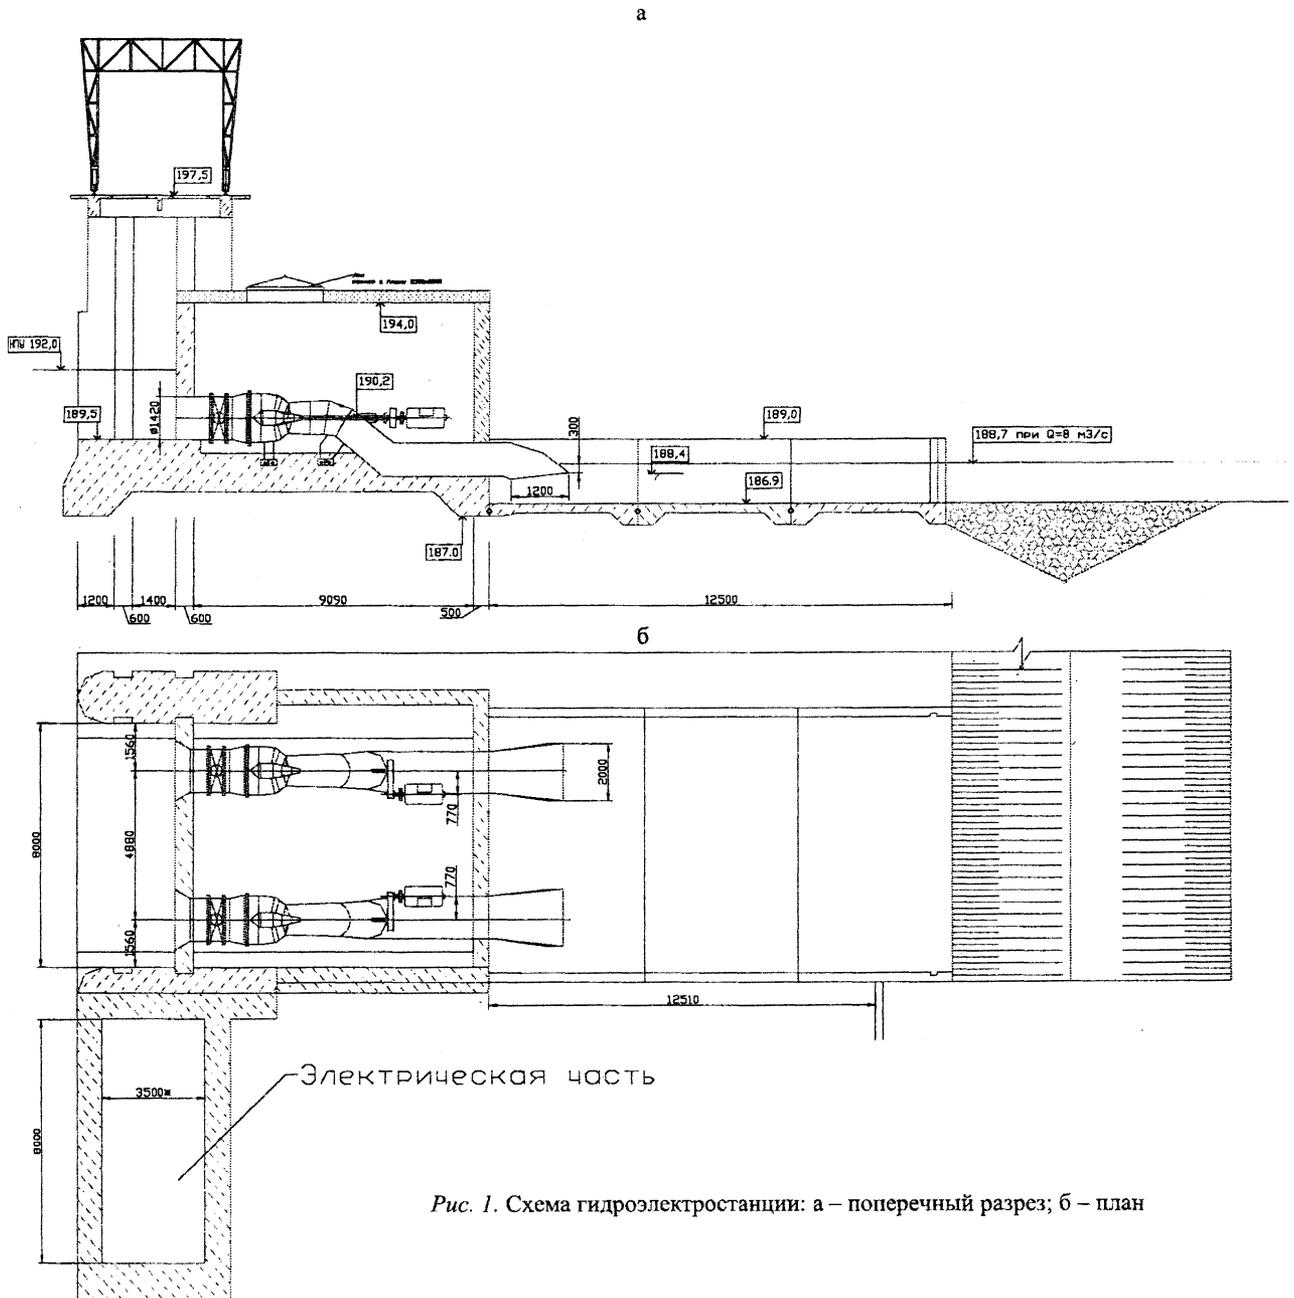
Схема гидроэлектростанции: а – поперечный разрез; б – план
